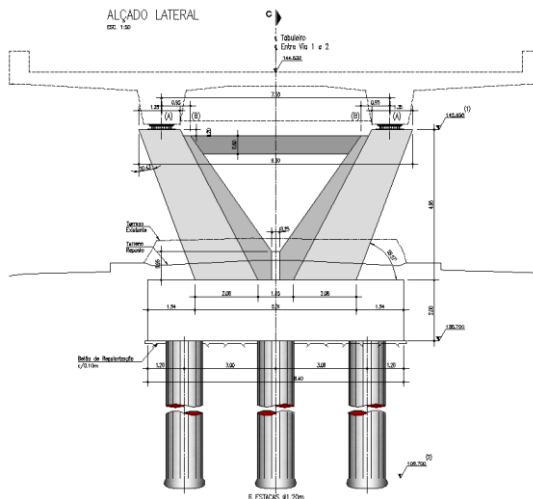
Alçado tipo dos pilares do Viaduto de Acesso Norte
